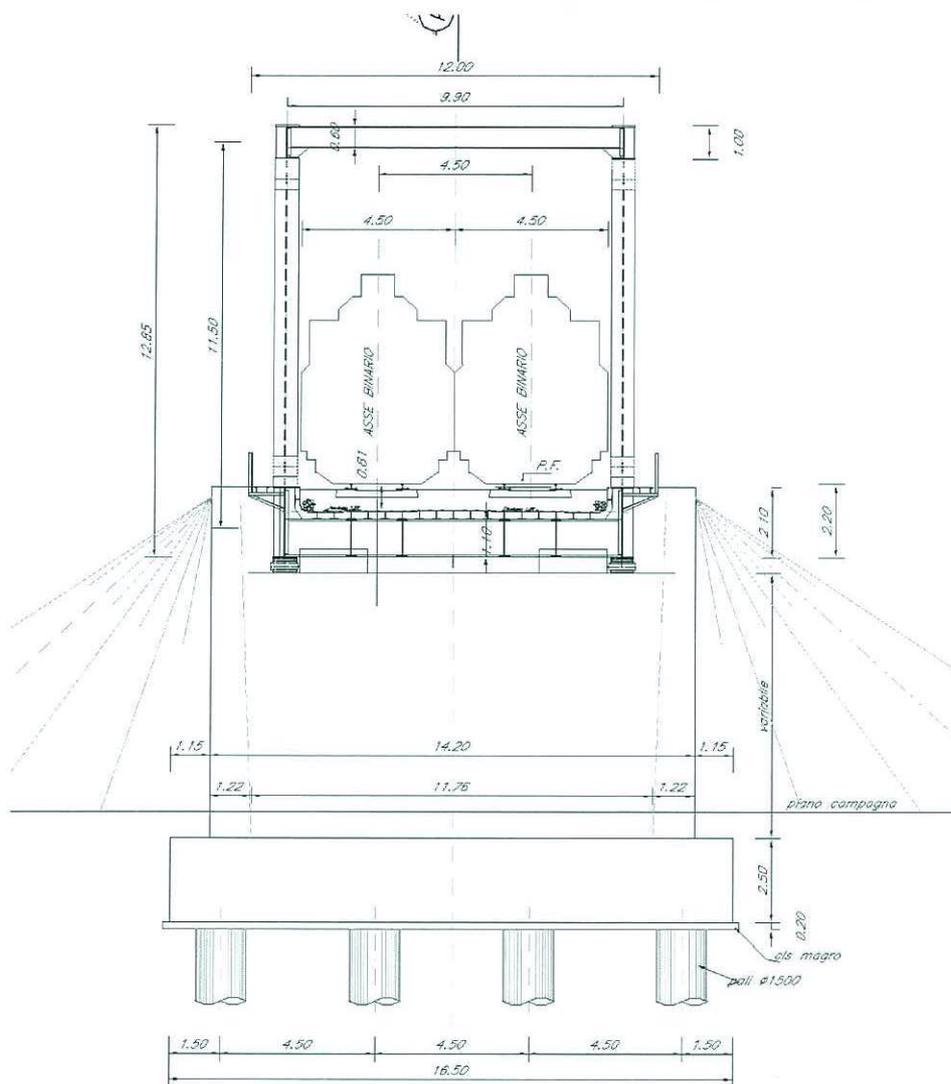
Sezione trasversale in asse appoggi della spalla tipo.
